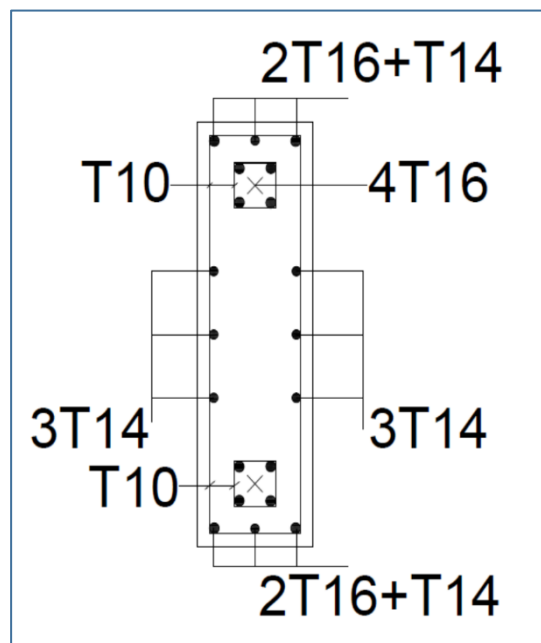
Coupe transversale de ferrailage des linteaux épaisseur 30cm.
